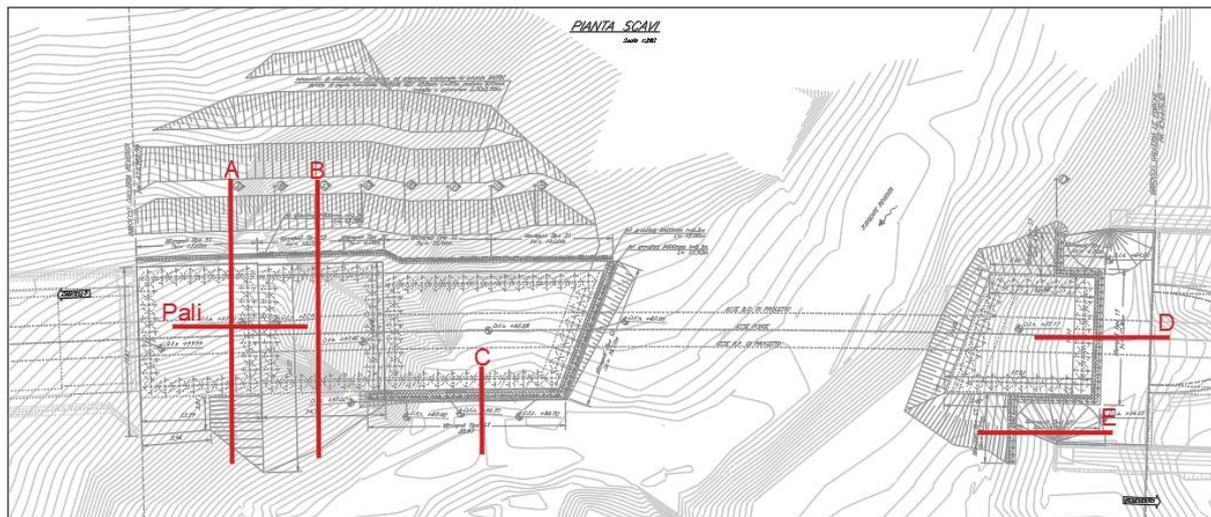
Pianta scavi ed opere provvisionali – Ponte sul Torrente Reventa
